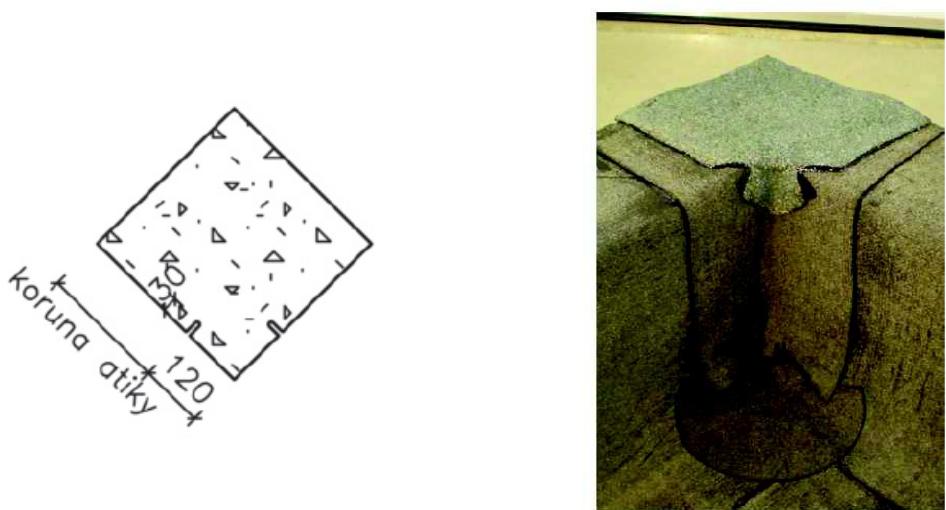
universální tvarovka 2 (převzato z [7])
